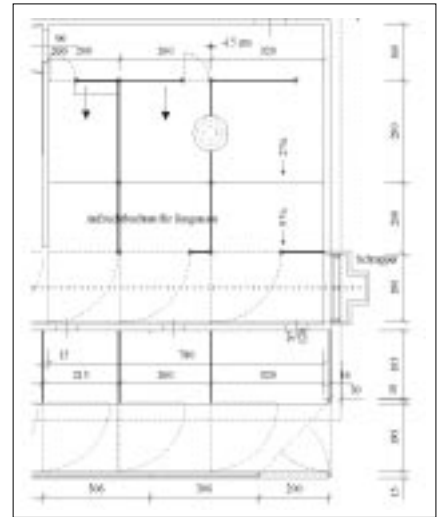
Schrägbodenbuchten für Jungsauern oder Mastschweine
